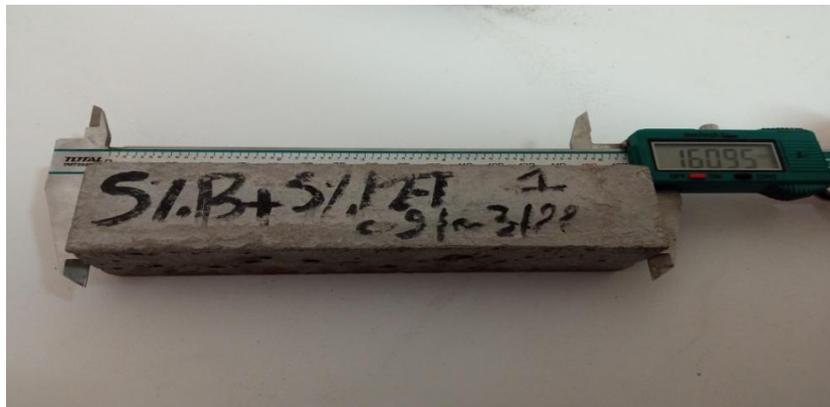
Mesure de dimension des eprouvettes par pied colleuse
